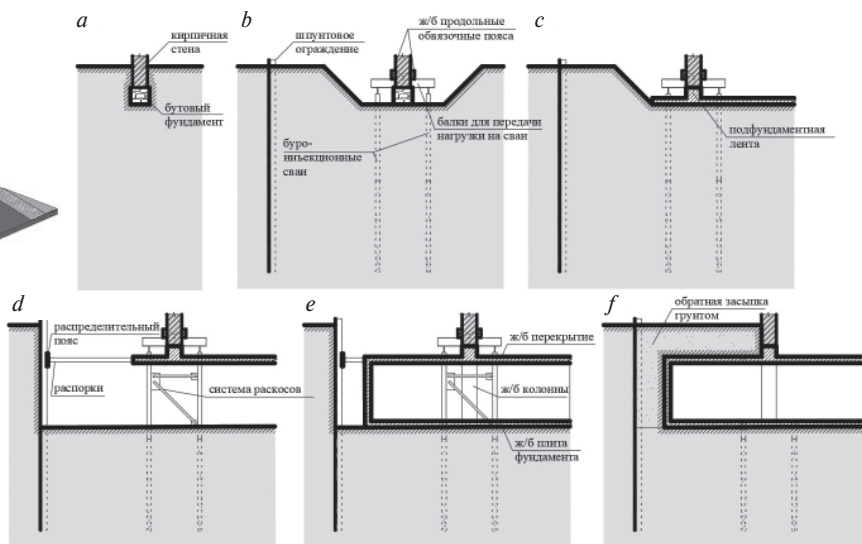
Процесс устройства подземного уровня под Каменноостровским театром: а – исторические стены и фундамент; б – вывешивание стен на буронабивных сваях и погружение шпунта в грунт; в – создание монолитной плиты и подфундаментной ленты; д – откапывание грунта, раскрепление ограждения котлована распорками; е – устройство стен, колонн и плитного фундамента подземного сооружения; ф – обратная засыпка грунта, демонтаж временных элементов конструкции
